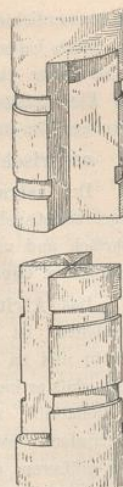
Aufpfropfen. Beide Hölzer sind so ausgeschnitten, daß sie kreuzförmig in einander greifen. Zwei schmiedeiserne Ringe, die durch eine Schraube fest angezogen werden können, pressen die Verbindungsteile fest an einander.
